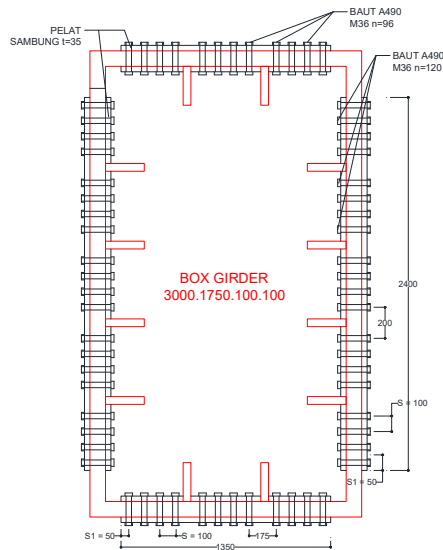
64 Sambungan (*Box Girder*) pada Badan
